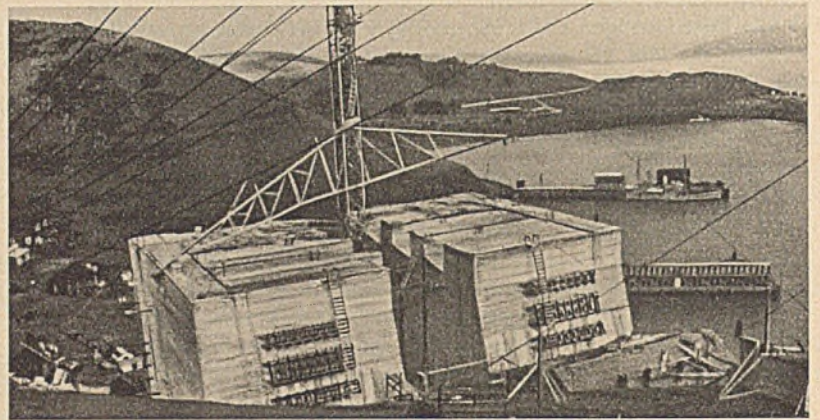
Nördliches Verankerungsbauwerk mit den 2 x 6r Augenstäben.
